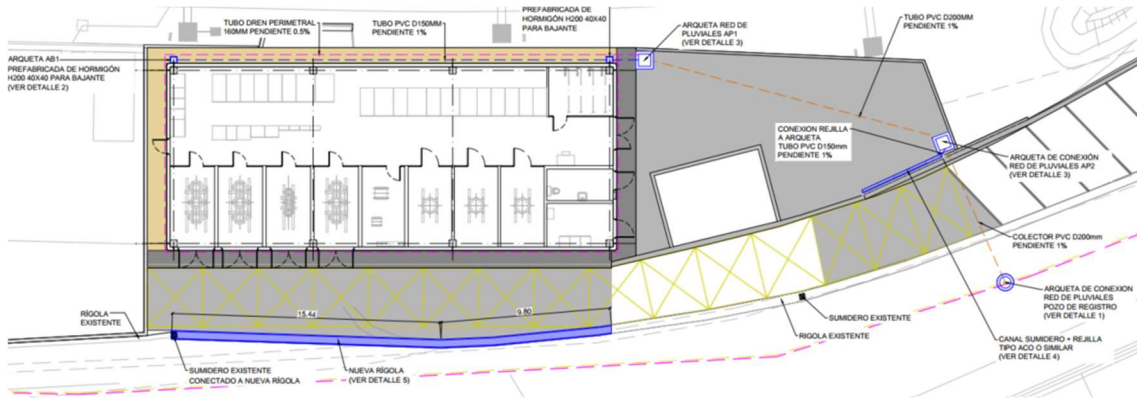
Drenaje de pluviales. Arquetas para bajantes
